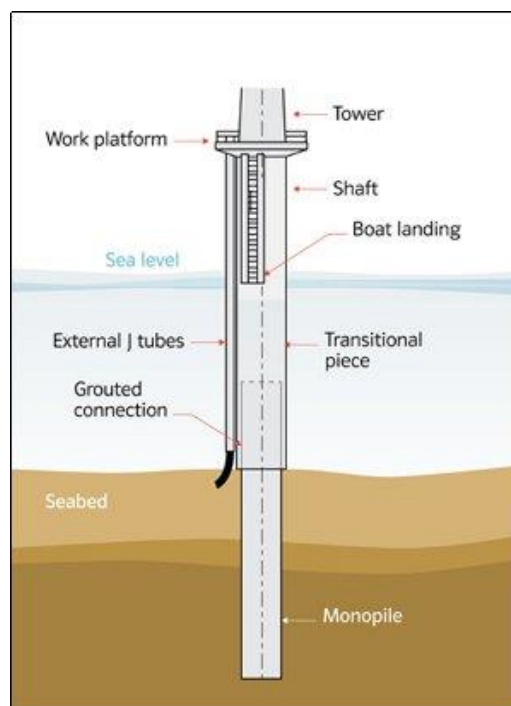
Typy základů u mořských instalací VTE [9]
